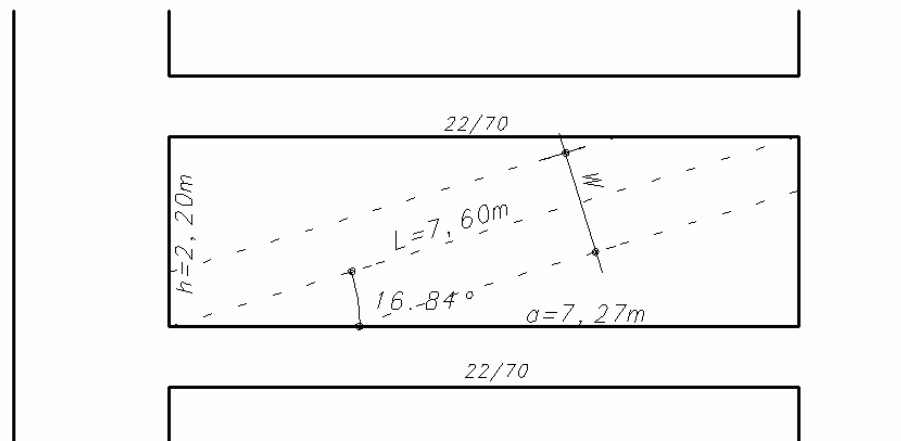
Pórtico 7=Pórtico 11(segundo proposta de Moreira,2002)
